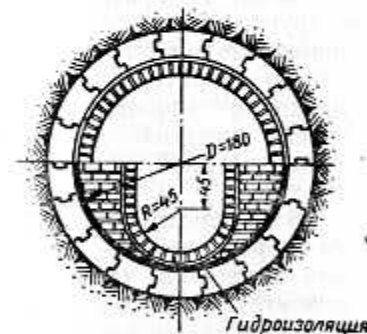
Конструкция туннеля из блоков с кирпичным лотком
